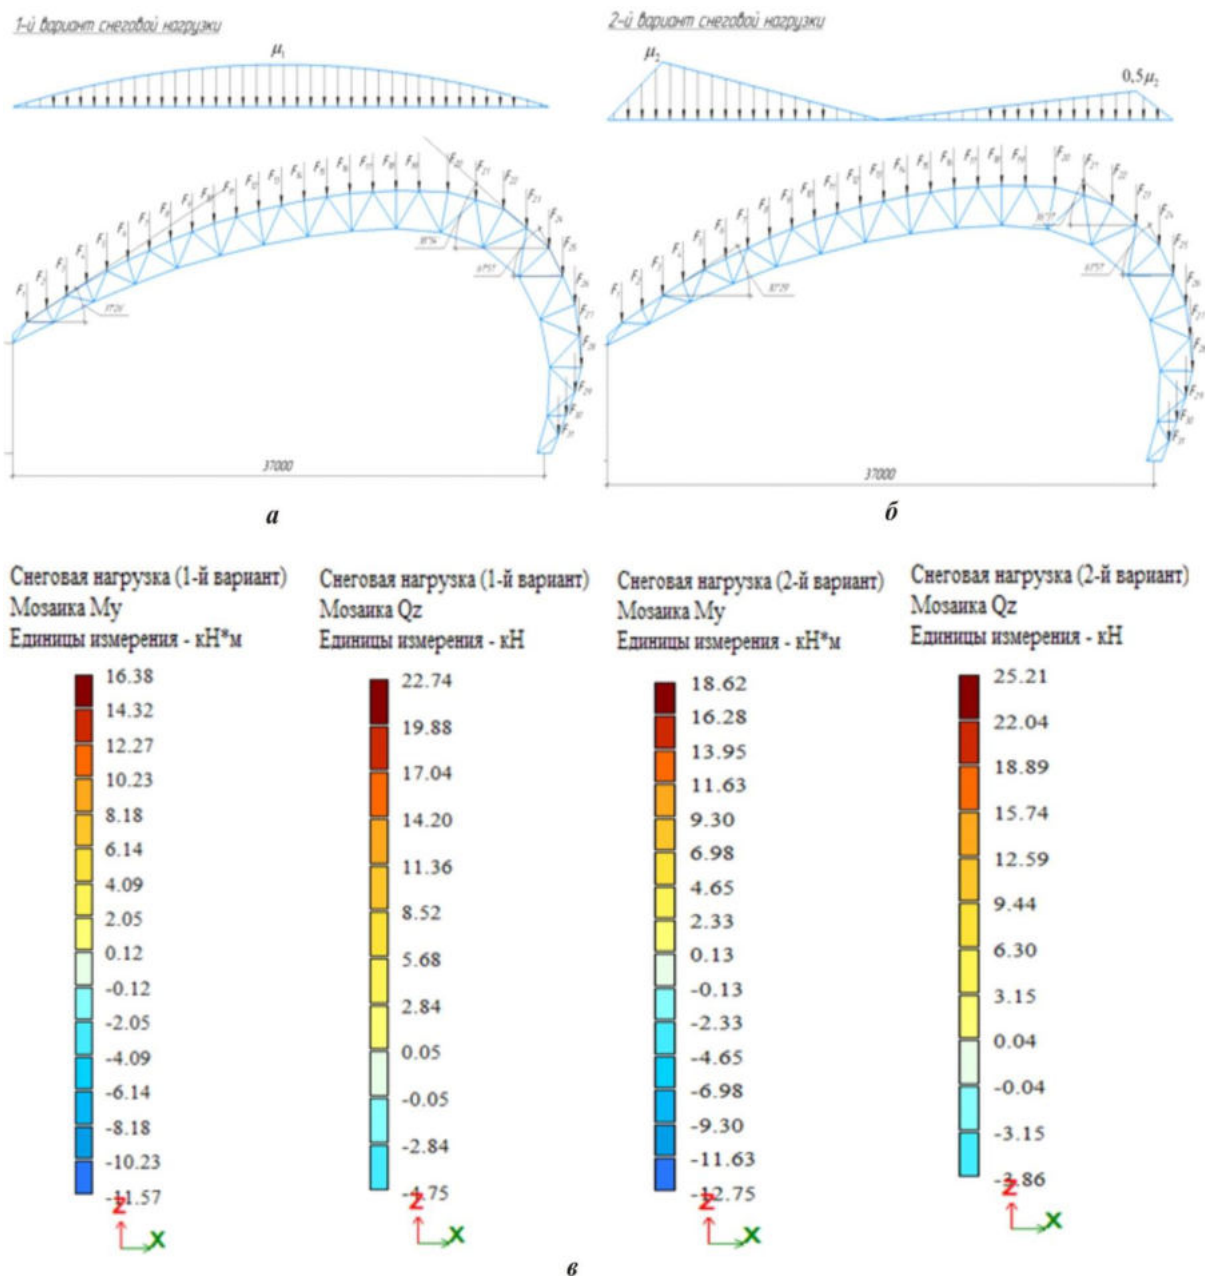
Воздействие снеговой нагрузки: а, б - схемы действия снеговой нагрузки при первом и втором вариантах загрузки; в – мозаика усилий в элементах фермы
